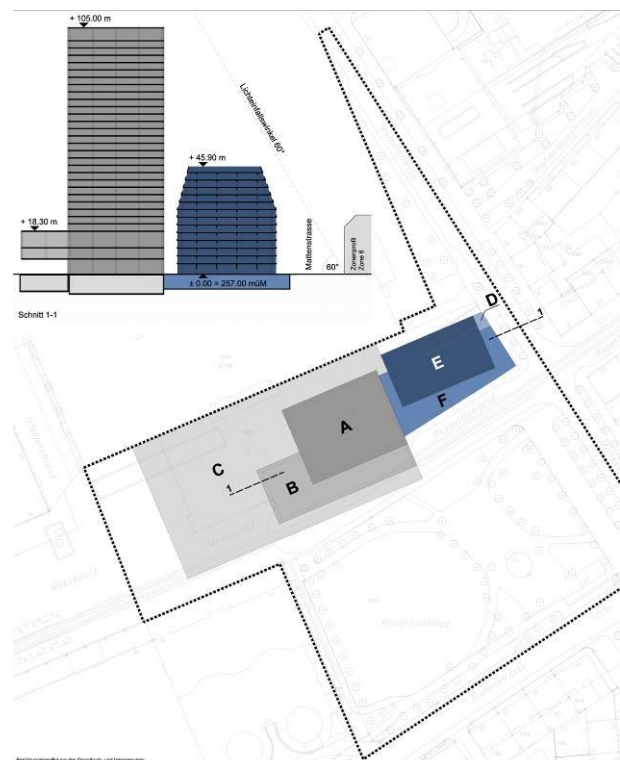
Bestehender Bebauungsplan Nr. 157 (PI-Nr. 13'542)
